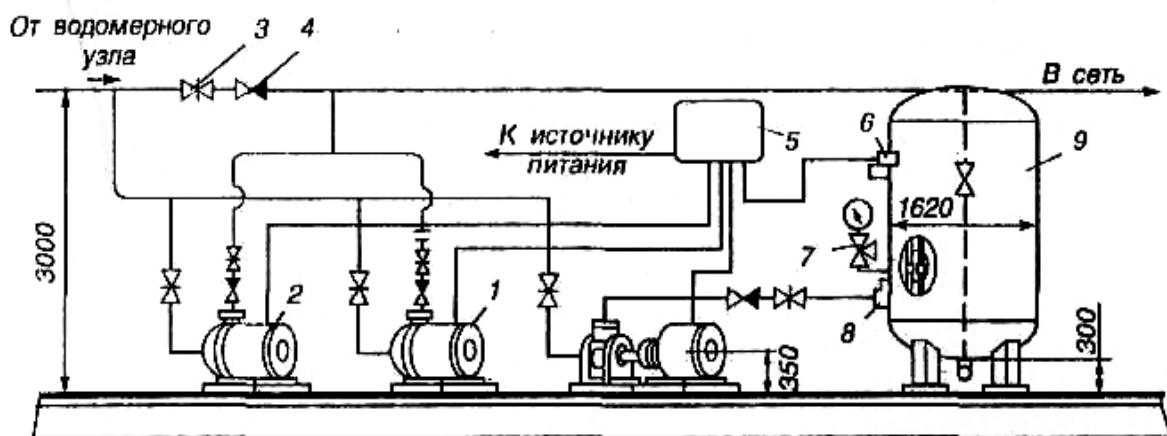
Схема типовой насосной установки с гидропневматическими баками: 1 – рабочие насосные агрегаты; 2 – резервный насосный агрегат; 3 – обратный клапан; 4 – задвижка; 5 – шкаф управления; 6 – реле давления; 7 – трехходовой кран с манометром; 8 – струйный регулятор запаса воздуха; 9 – гидропневматический бак
